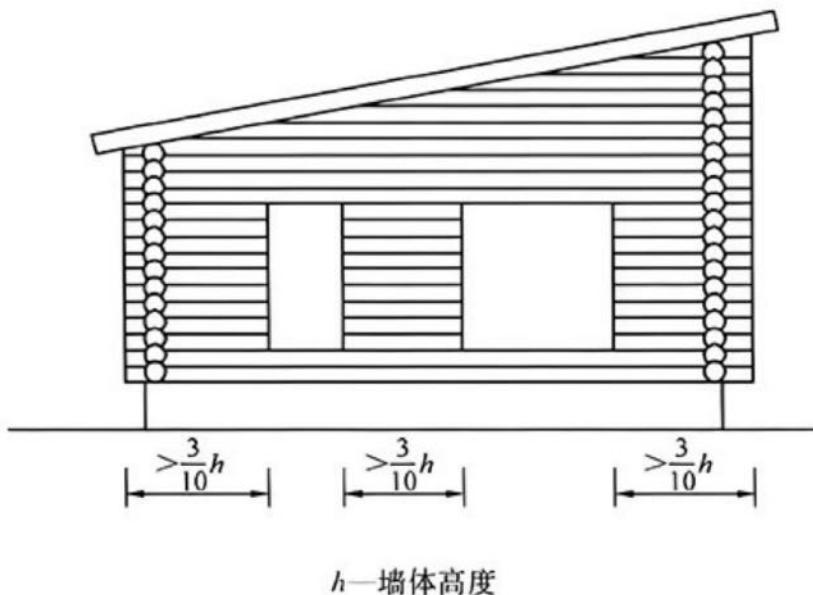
不连续墙体各段承重墙宽度示意
